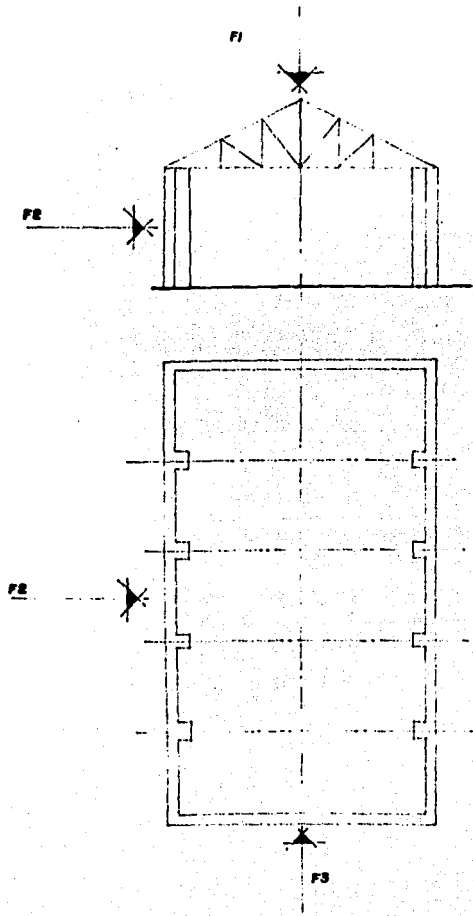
Fuerzas exteriores sobre la nave.
